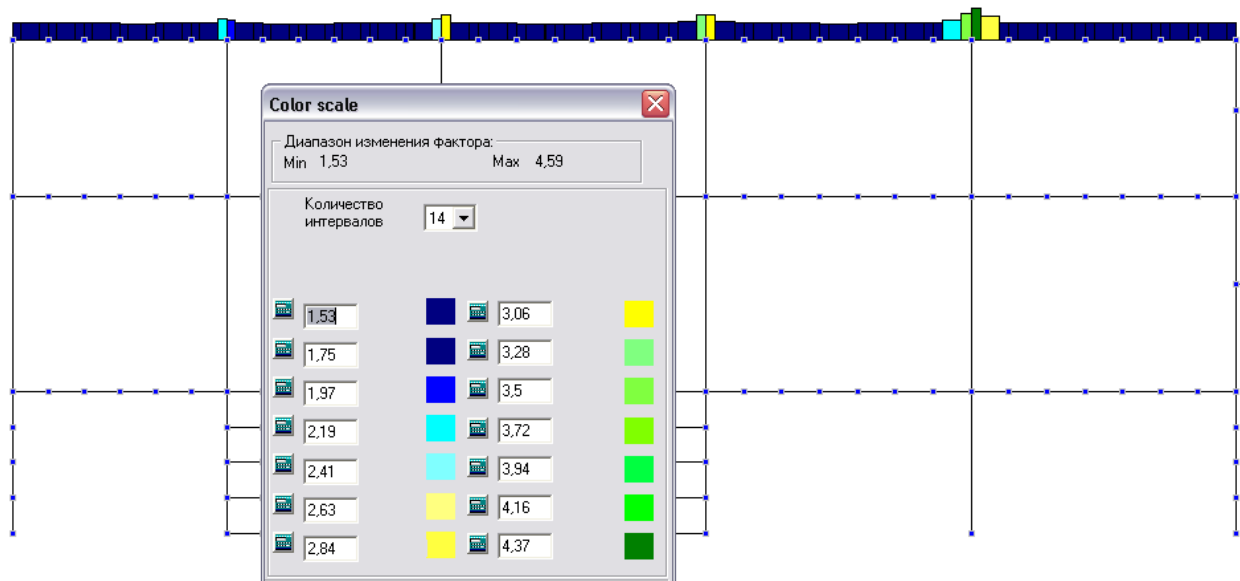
Цветовое отображение армирования монолитного ригеля (верхняя арматура)
